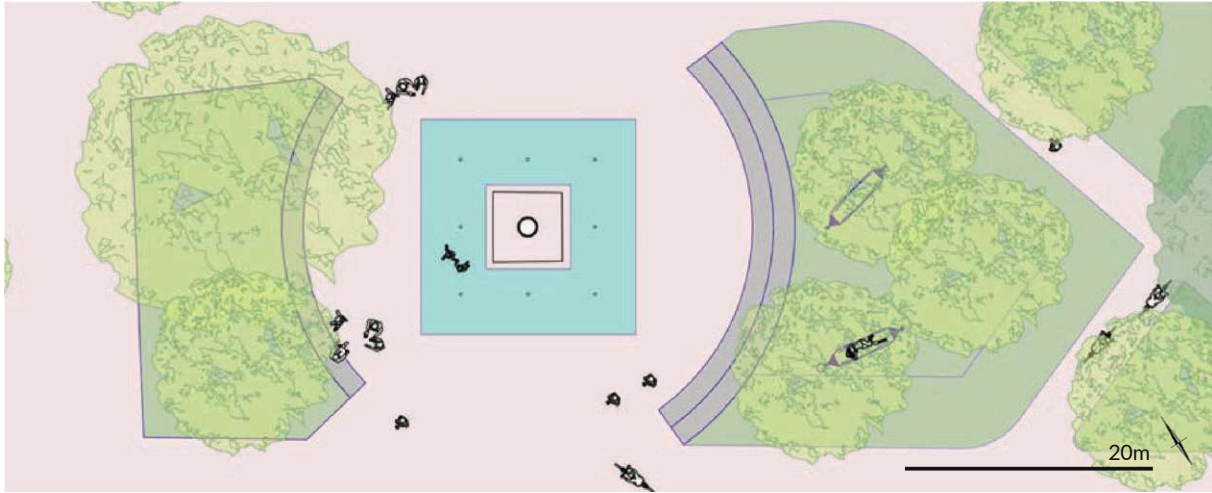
Grundrissausschnitt Platz beim Alten Rathaus, eigene Darstellung
